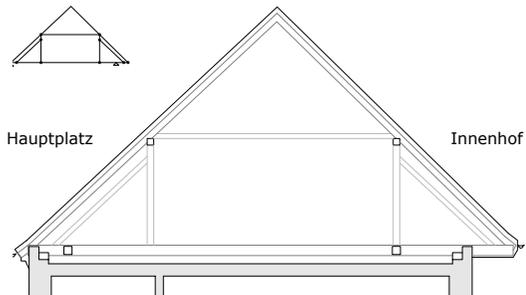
Dachstuhl Bürgerhaus \_ zweifaches Hängewerk
